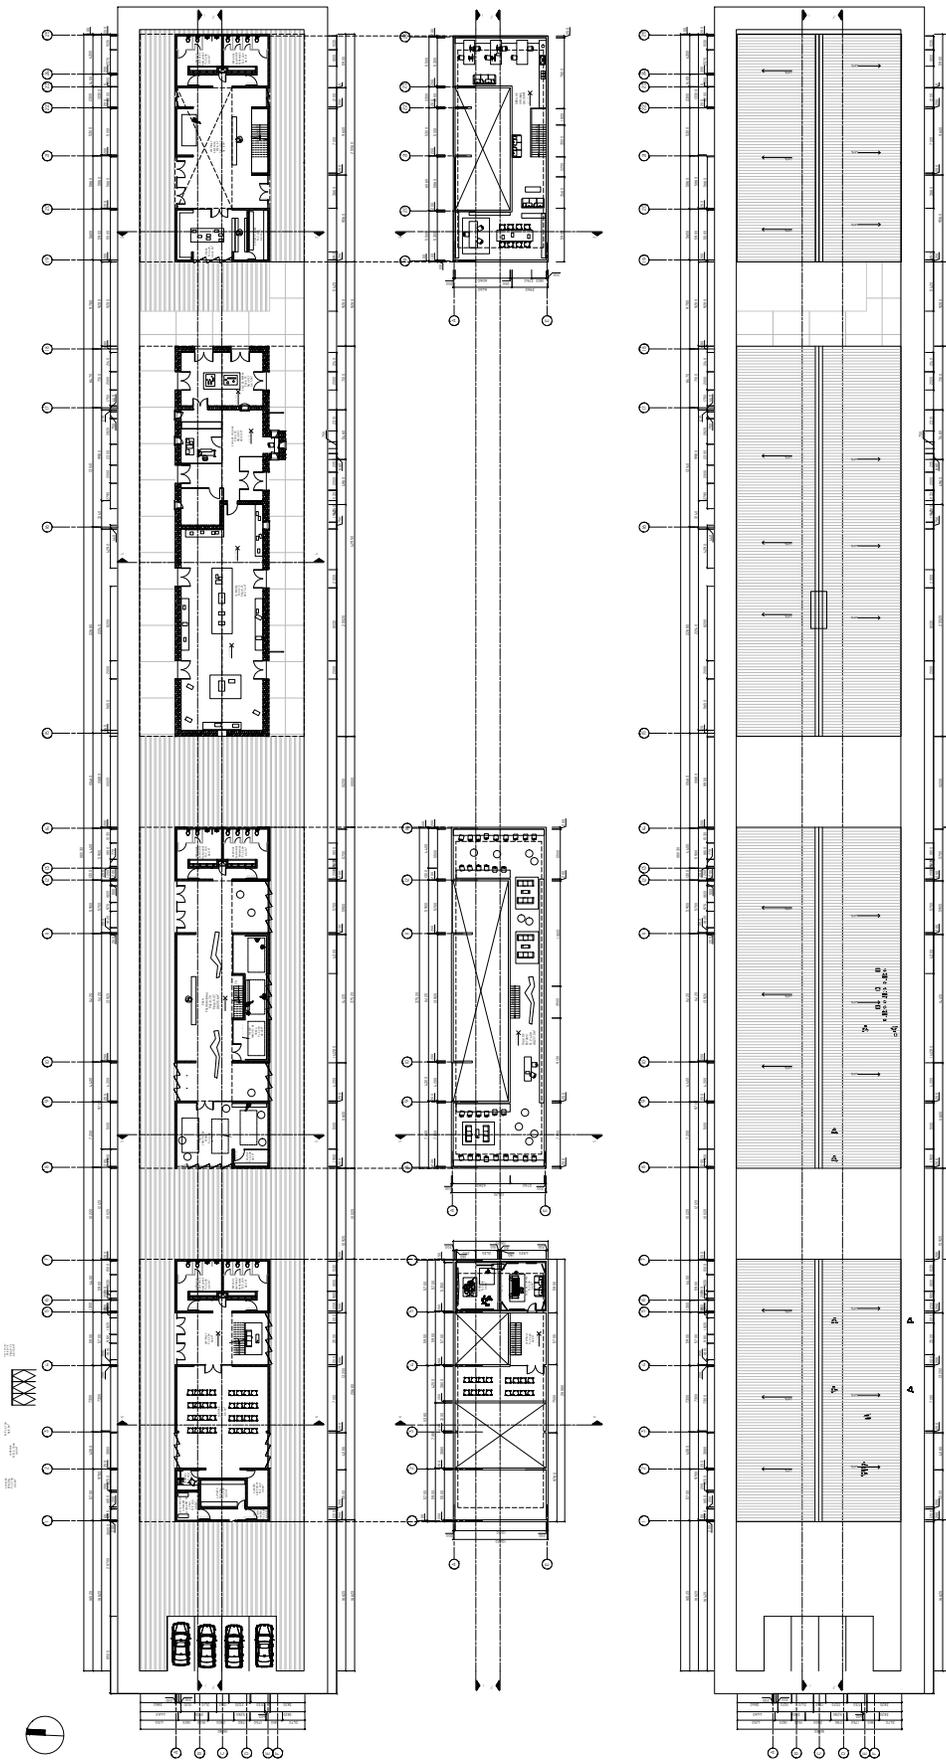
\_ Plano +0.00; plano +2.70; y sistema de cubierta
